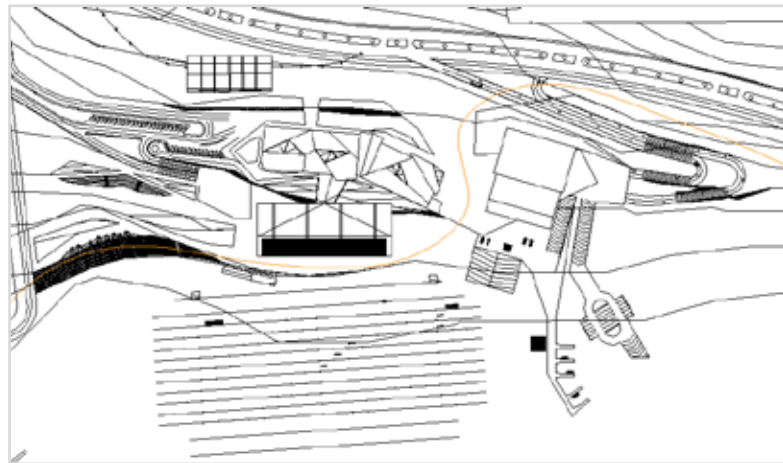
Planta Conjunto, Centro de Tecnificación de Paracanutaje.(2016)
